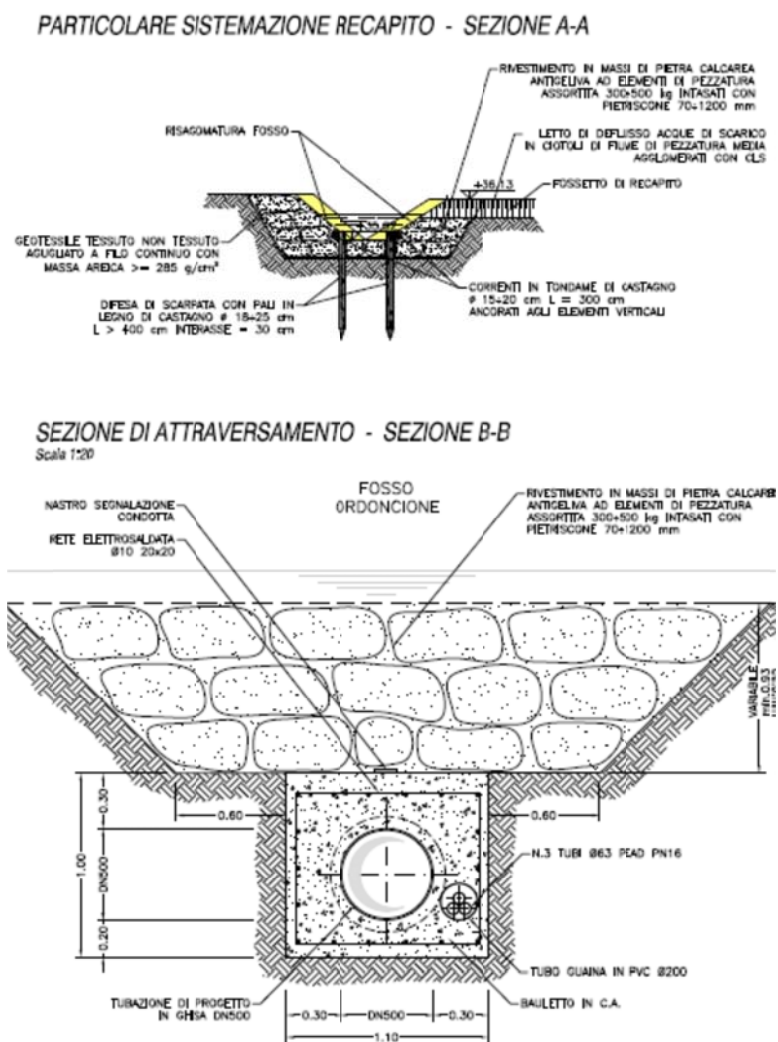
Particolare sistemazione II° attraversamento fosso Ordoncione
